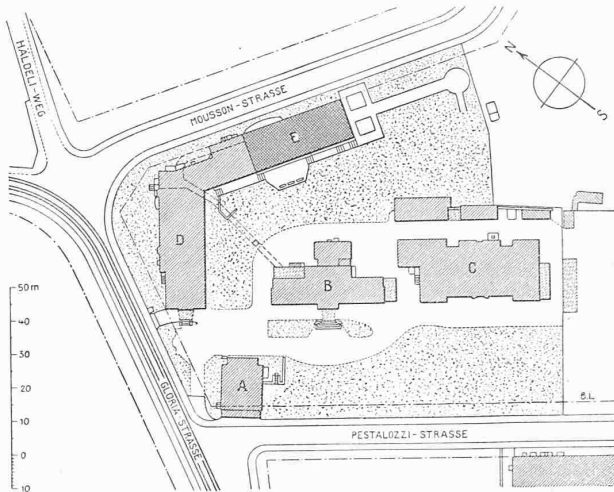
Lageplan 1:2000. — A Altes Haus; B 1887 erbaut; C 1900; D 1914; E 1926 erbaut.
